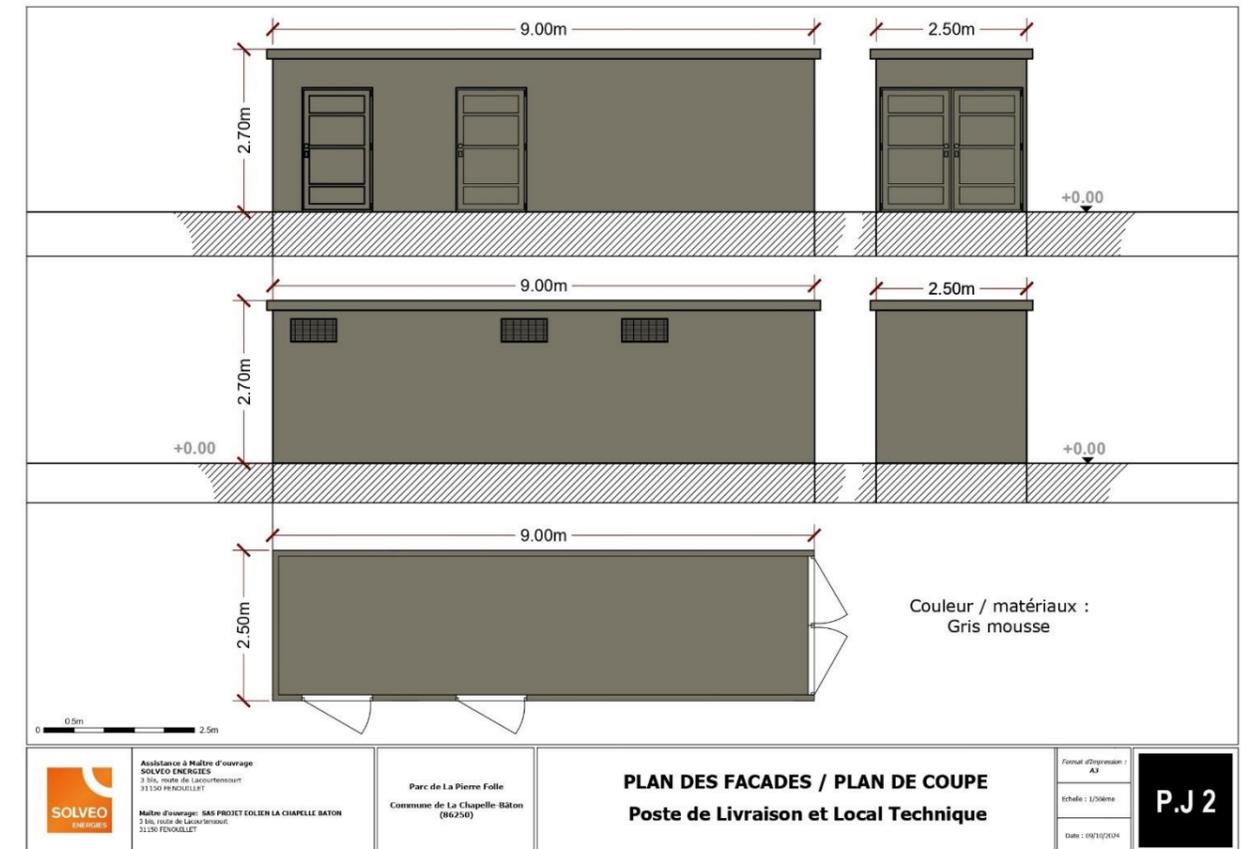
Plans des façades et plans de coupe du poste de livraison et du local technique (source : SOLVEO)
